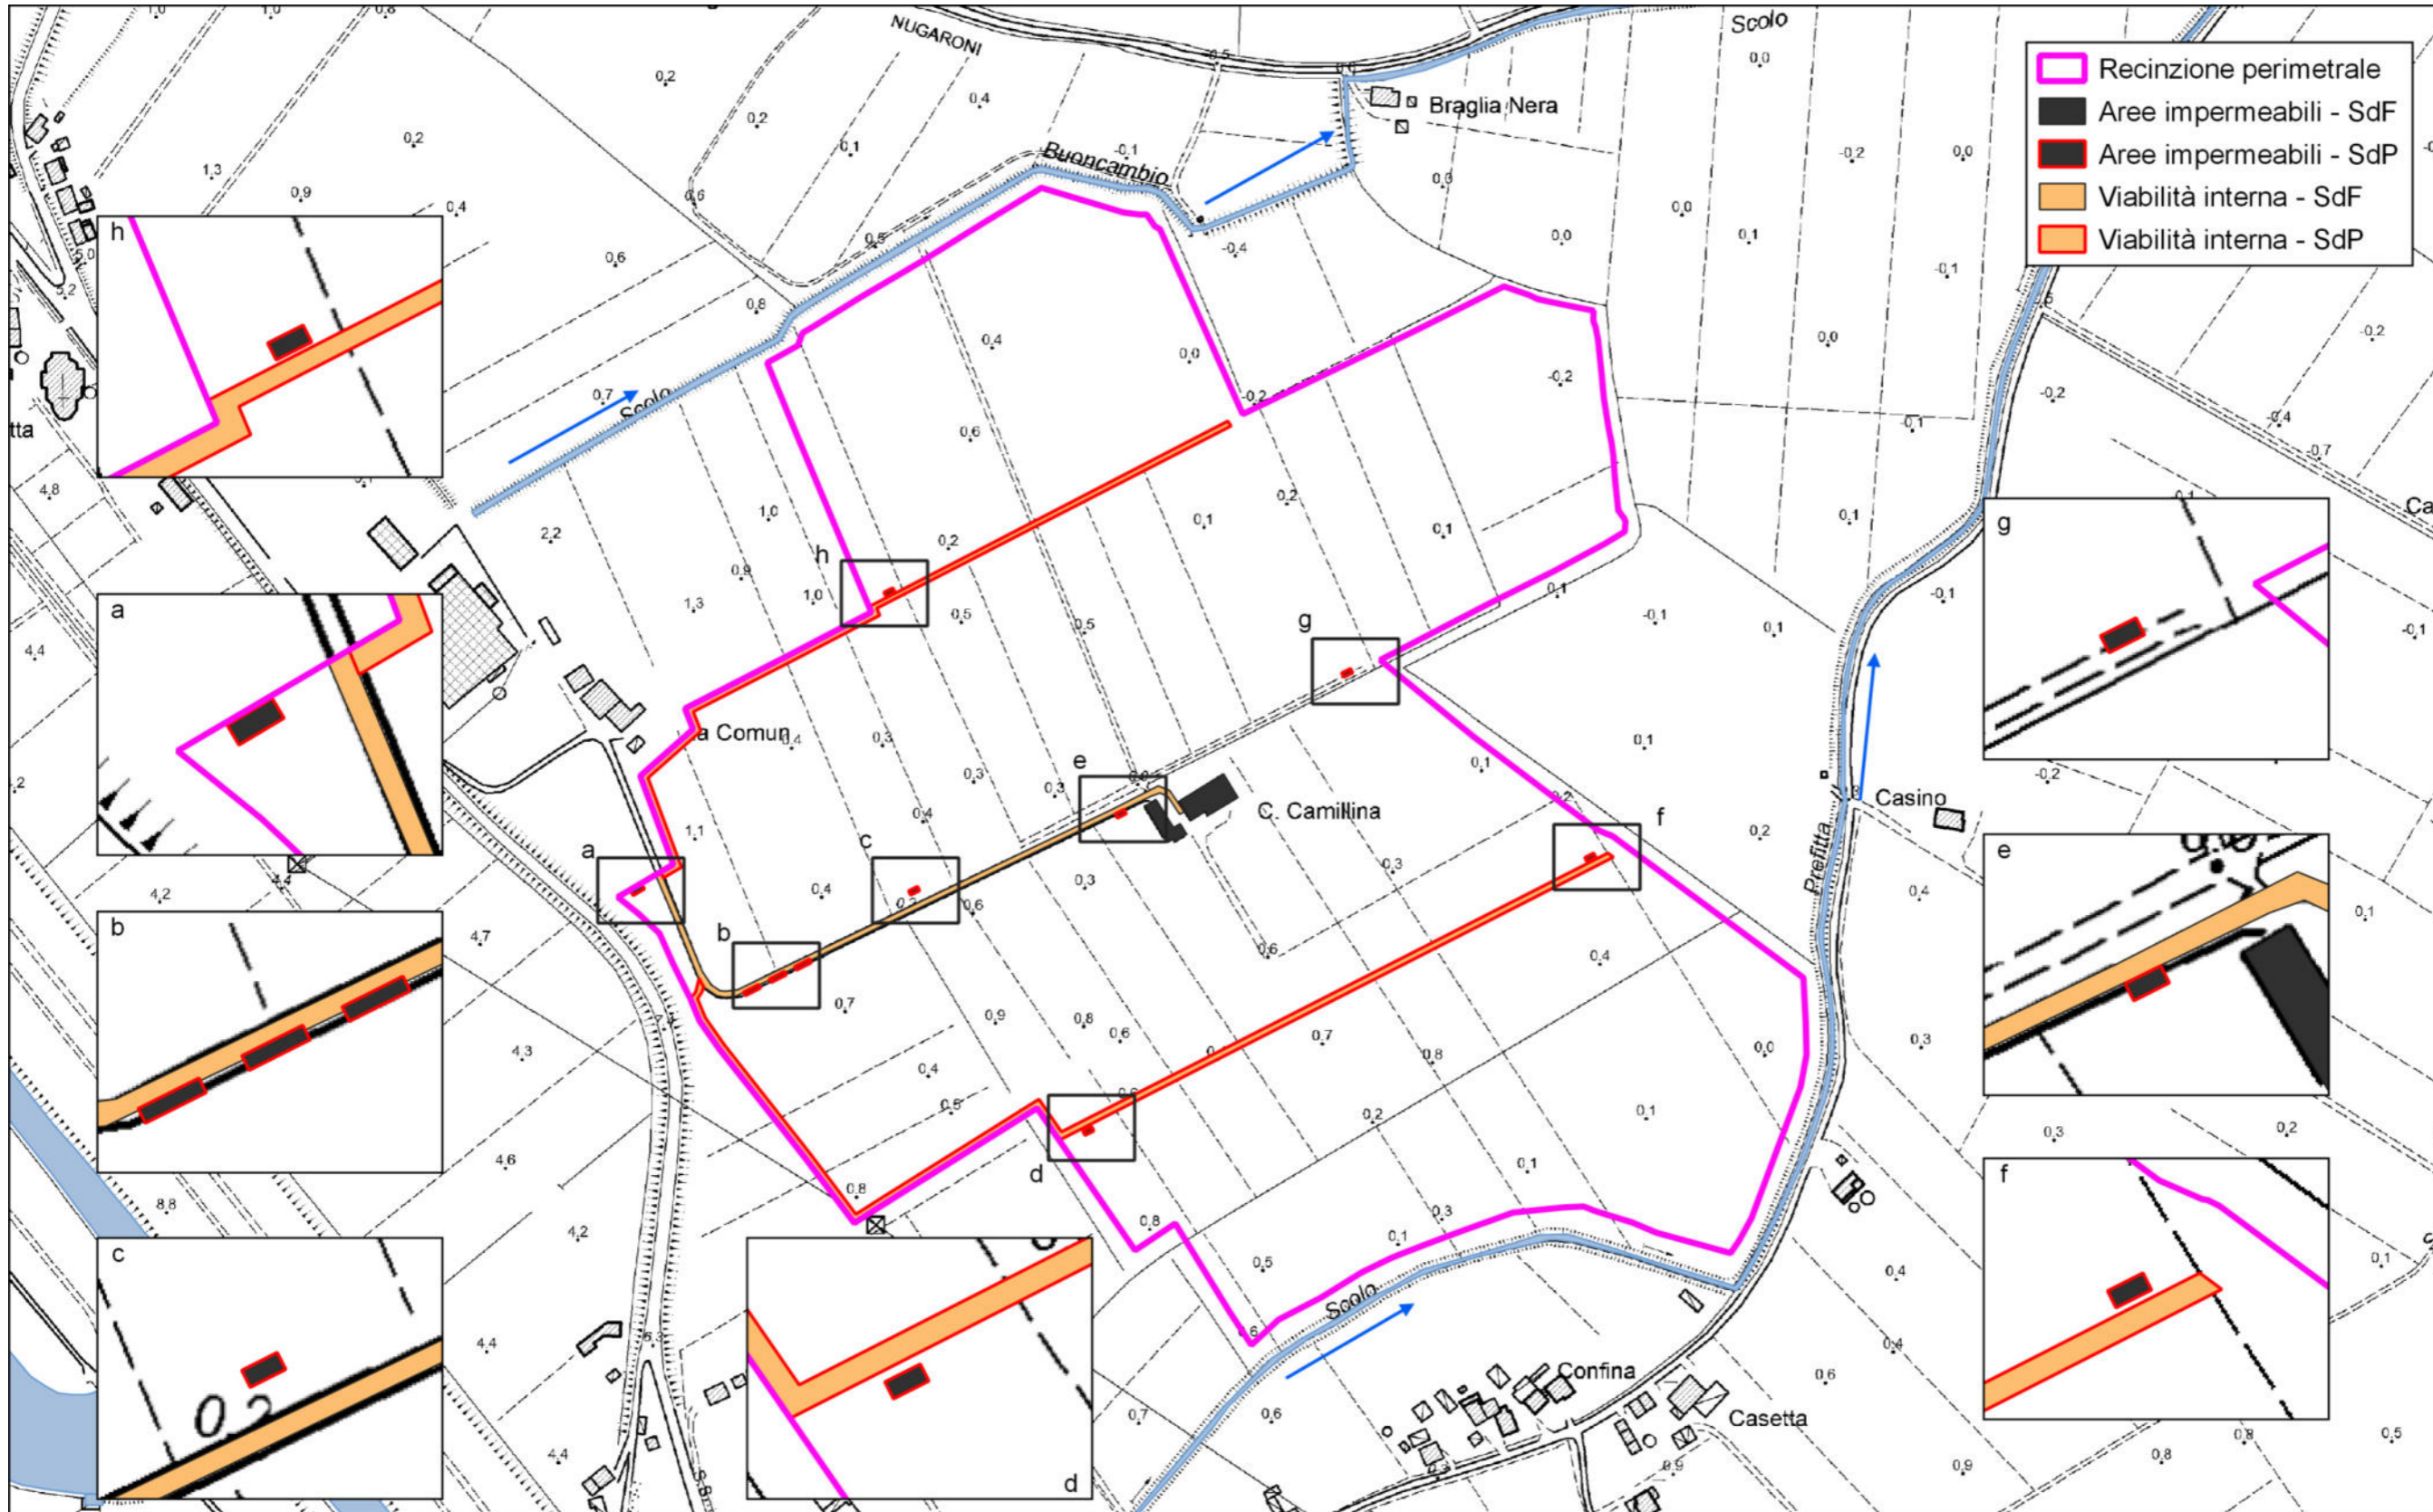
Localizzazione dei manufatti che determinano l'impermeabilizzazione del suolo all'interno dell'area di impianto. (SdF: Stato di Fatto; SdP: Stato di Progetto)
